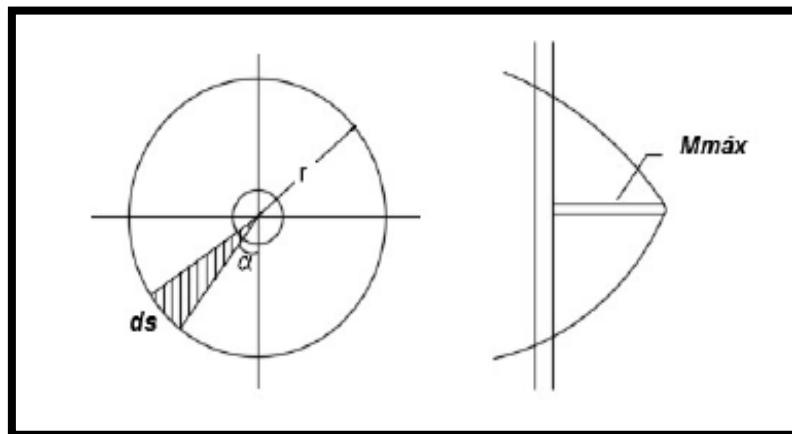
Vista en planta y perfil de escalera helicoidal con apoyo central. Alvarez (2017).
